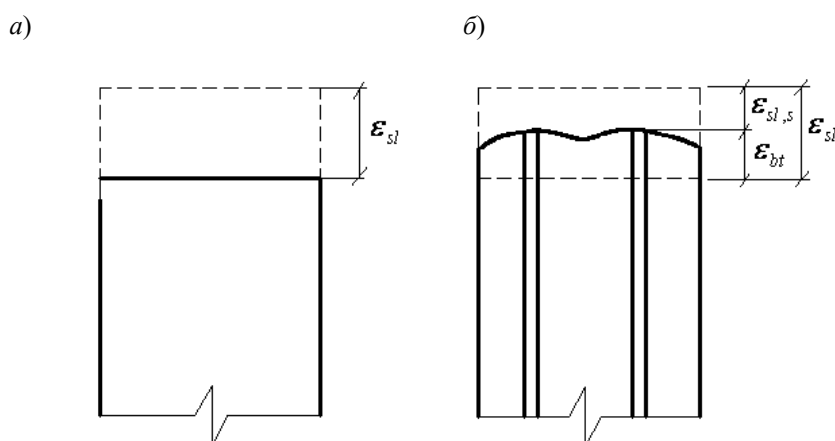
Деформации усадки образцов: а – бетонного; б – железобетонного
